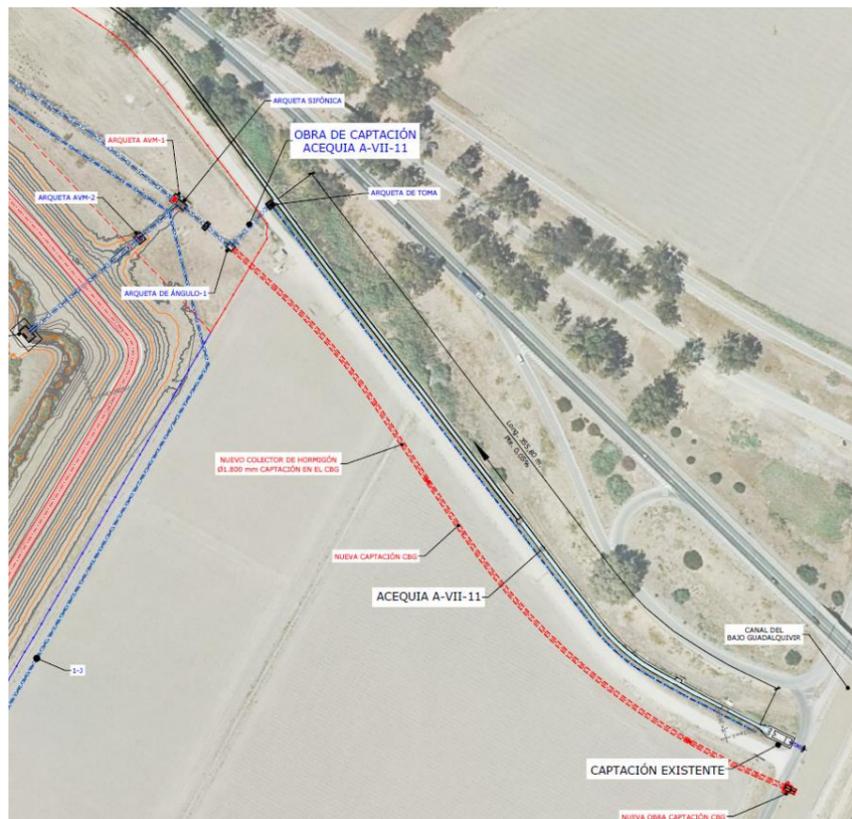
Planta de situación de las obras de captación del sector Alcantarillas. Existente en acequia A-VII-11 y nueva captación paralela
